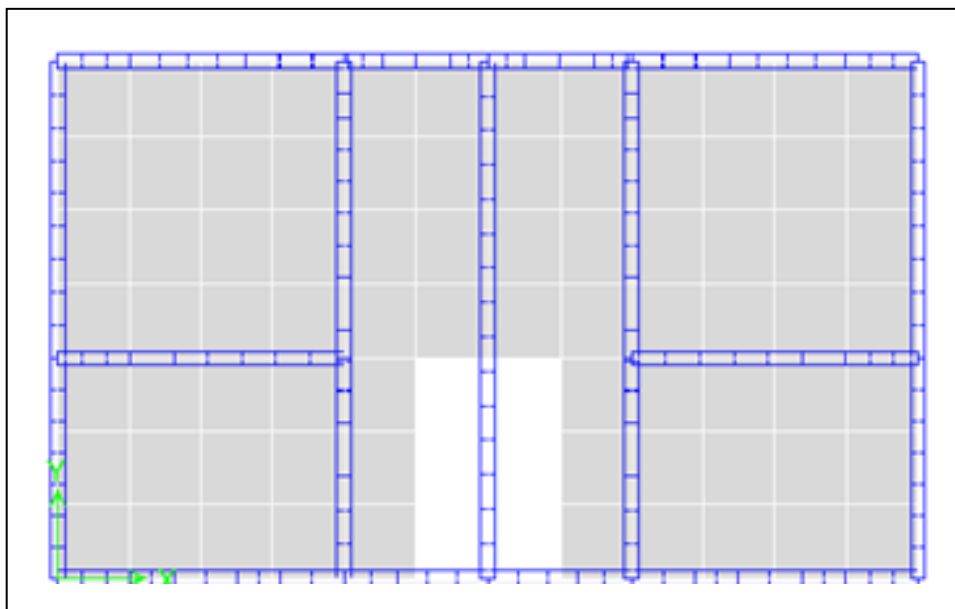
, Planta de estructura. Autor: ingeniero Richard Vásquez.
